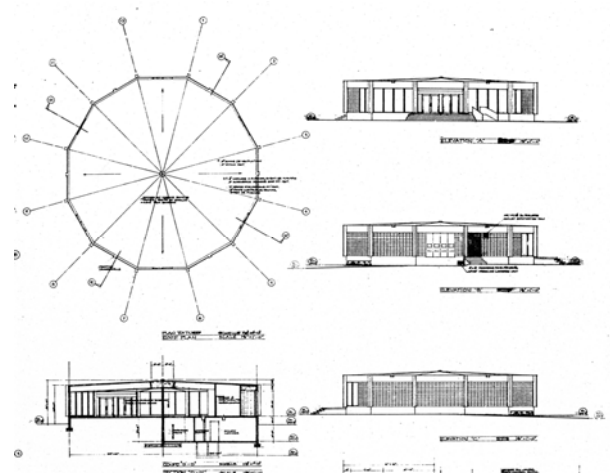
Plan et élévations du Service Bancaire, île Verte (1966)
